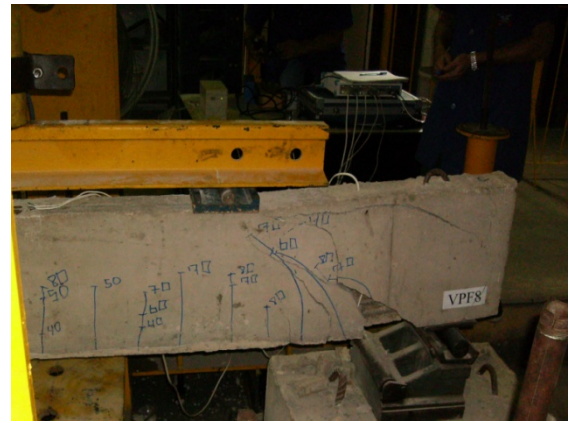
Padrão de fissuração da viga VPF8 (ruína por cisalhamento)
